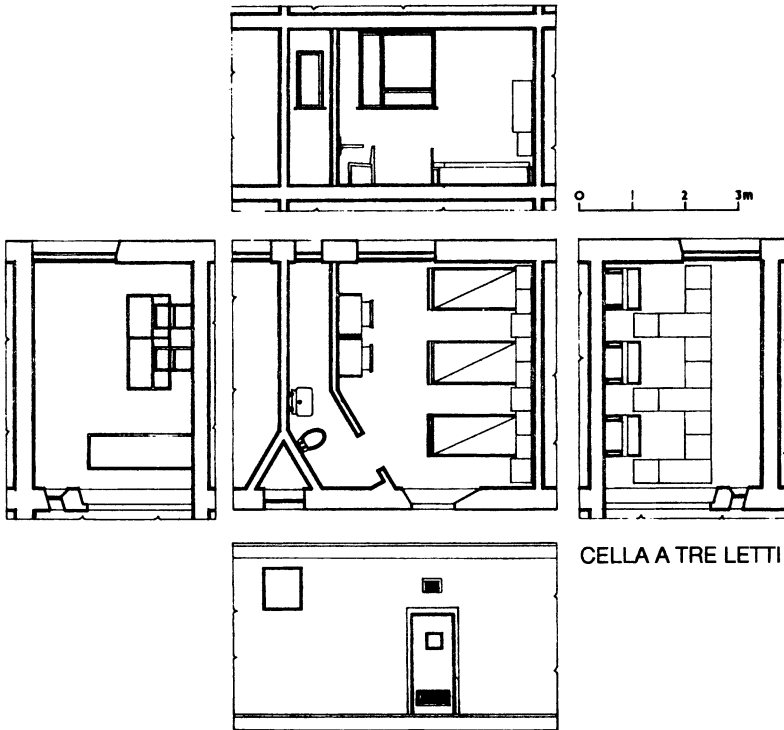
Arch. S. Lenci - Pianta e sezione cella a tre letti
